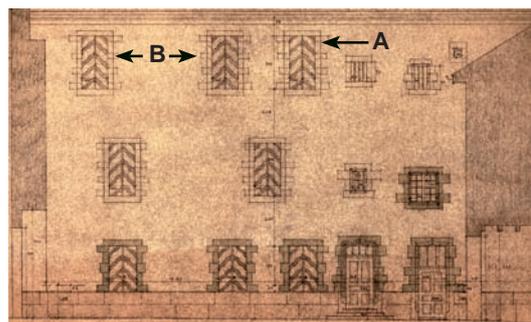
Façade sud (ACPU, AA 2.1.0.3)
